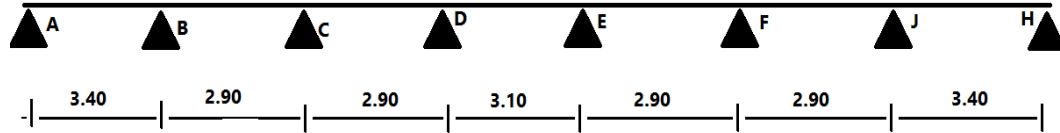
Schéma du 1^{eme} type de poutrelle.
